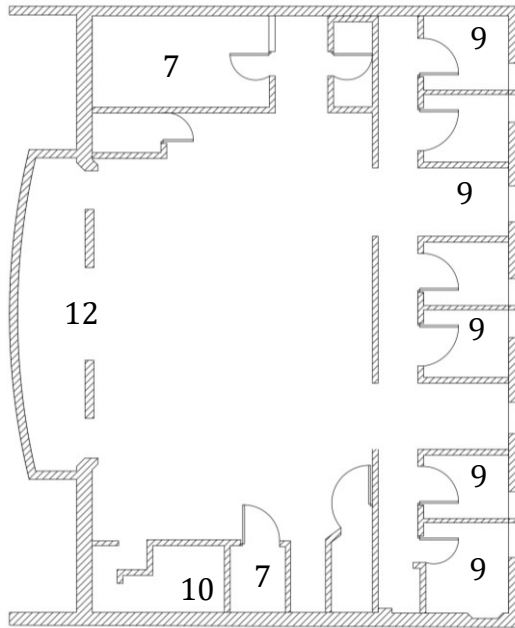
Planta original, Piso -1, Fonte: Autor
